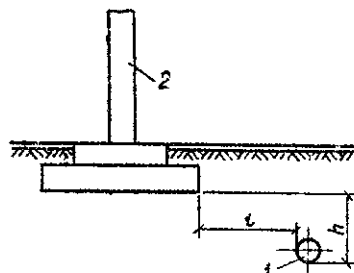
Прокладка подземной водосточной сети вдоль колонн
